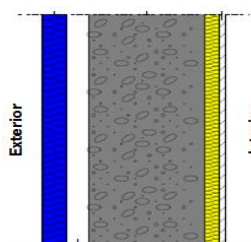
Pormenor das paredes exteriores – Par\_Ext\_1.
